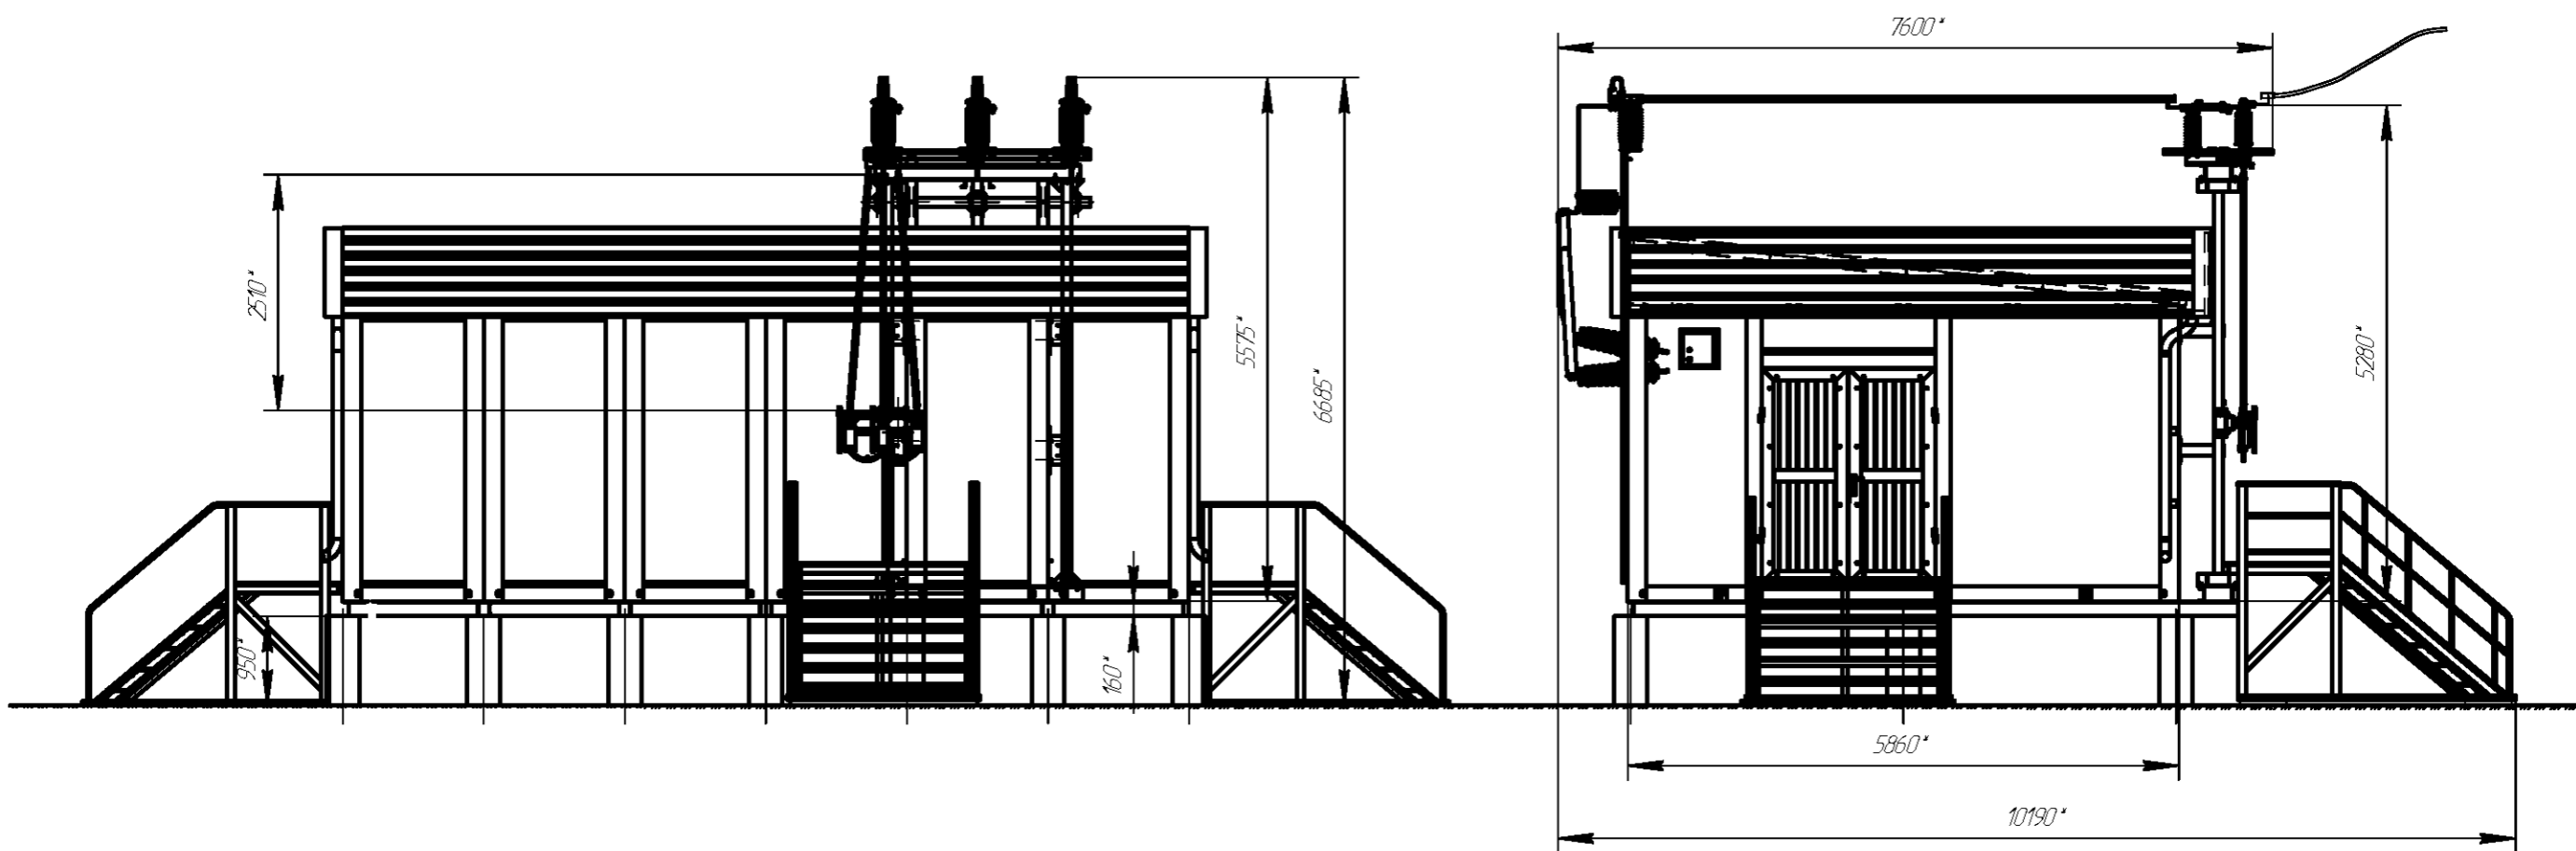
Блок разъединителя на фундаменте КРПЗ-35 УХ/11
